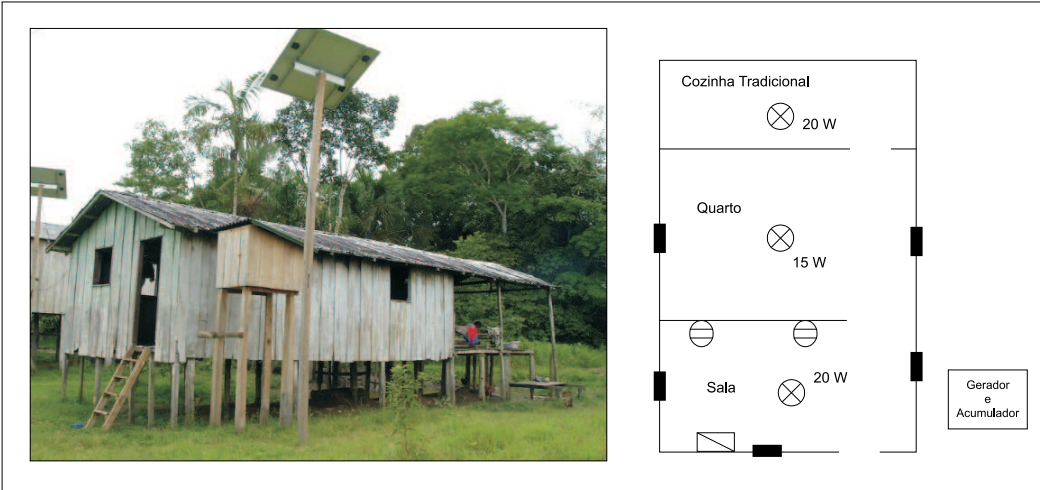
Vista externa do SFD3 e planta aproximada do domicílio.
